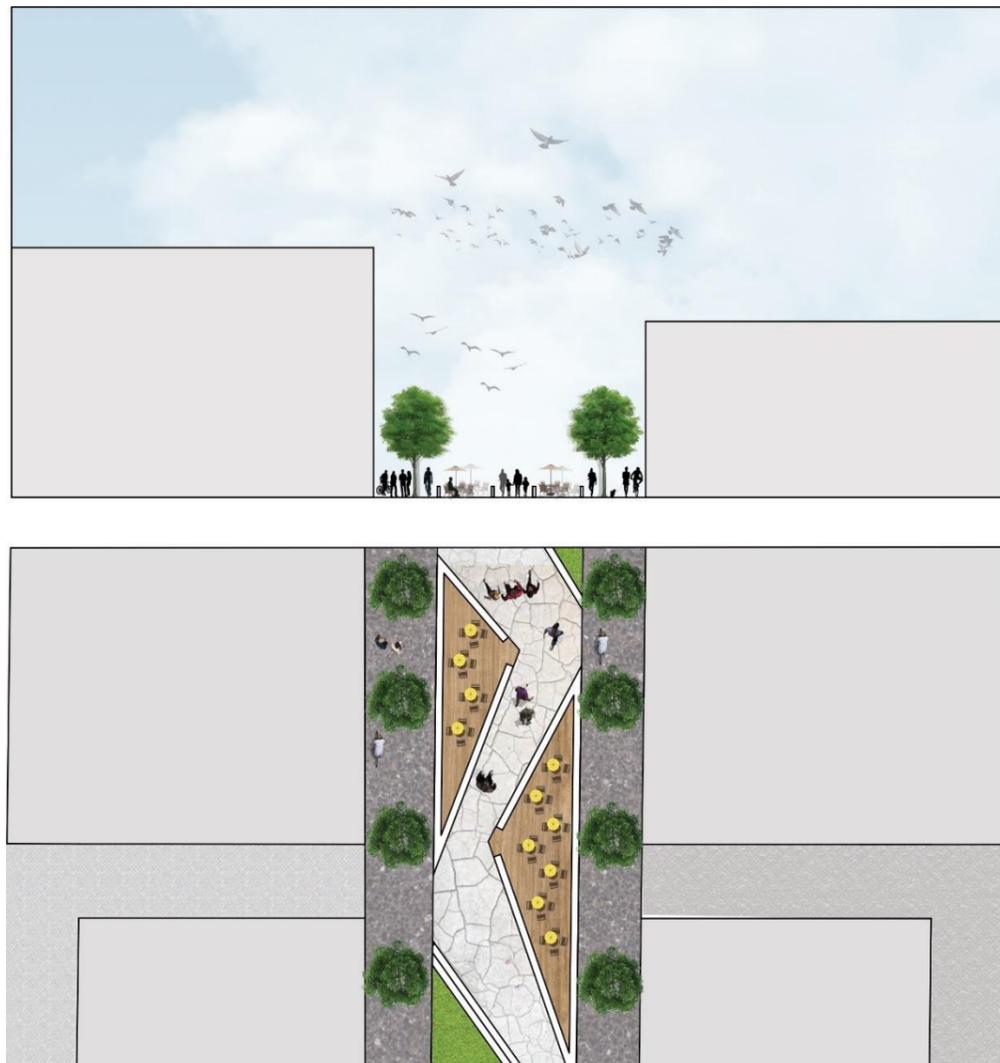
Plan coupe de la promenade .Source : auteur 2022
